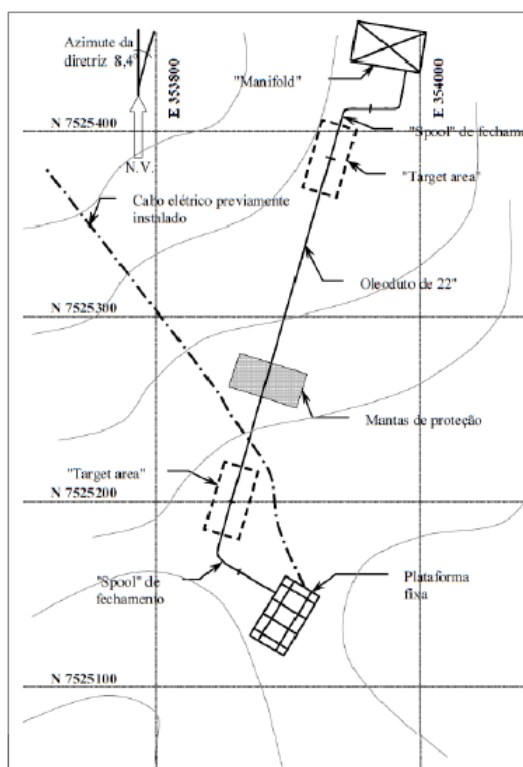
Exemplo do traçado em planta da rota de um duto [9].
